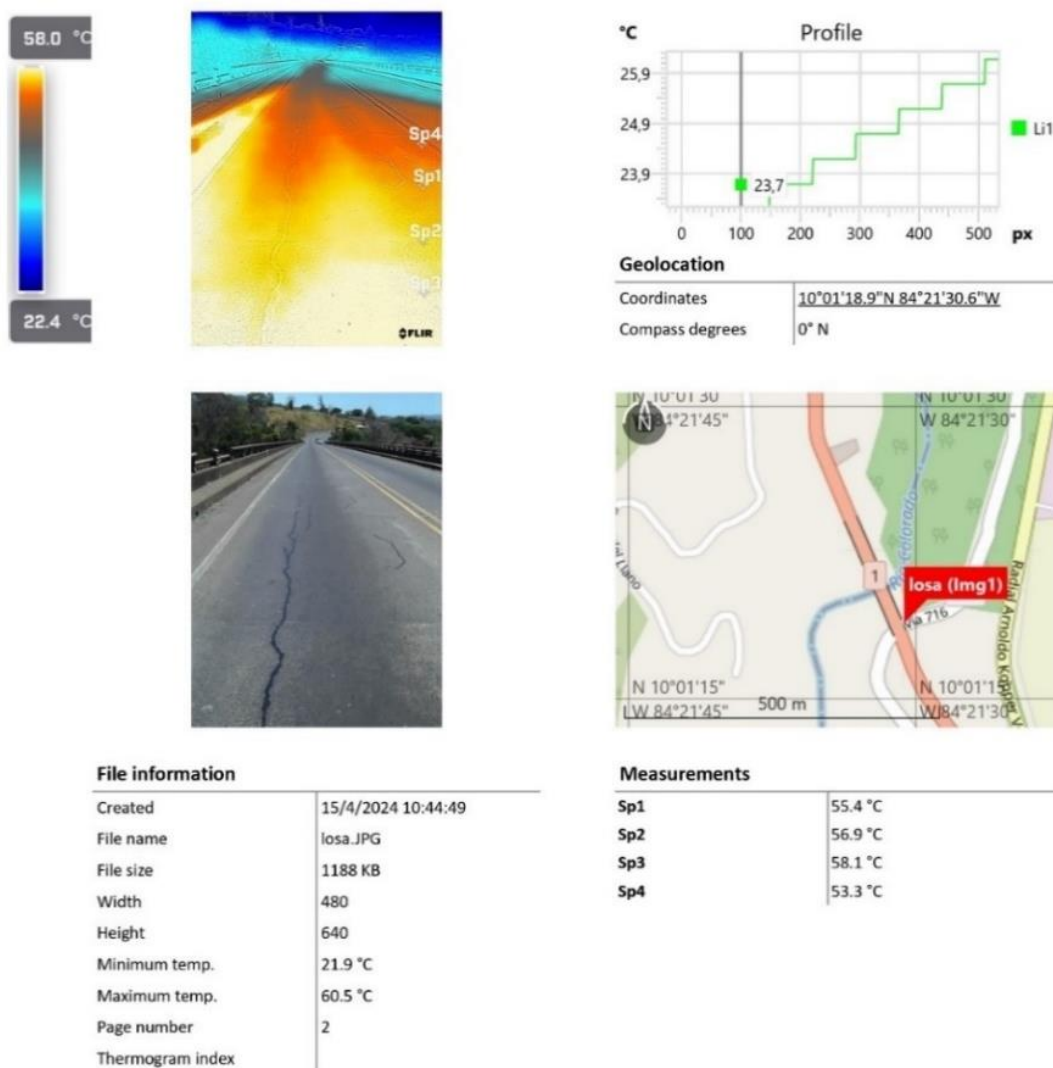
16 Reporte térmico de grietas en una dirección de la losa en la sección No. 2
